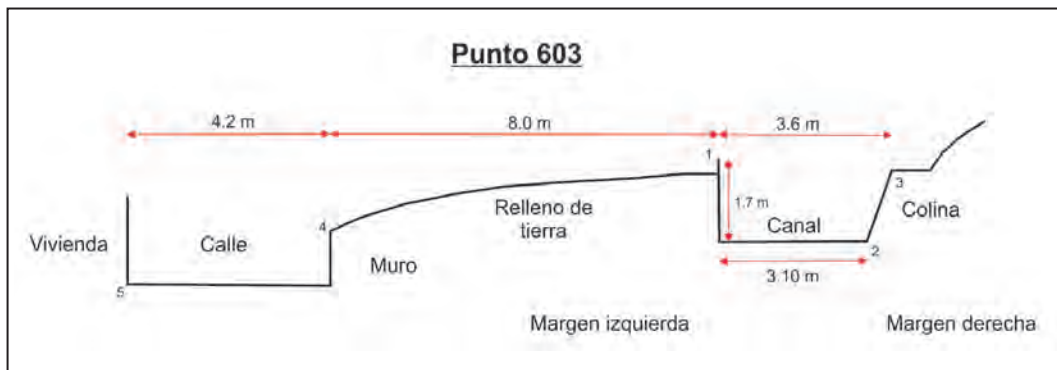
Sección transversal medida en la calle Capitán Novoa (punto de control n° 603), donde se puede observar el muro de encauzamiento de concreto y el relleno de tierra colocado en la cara posterior del muro; también, se puede observar claramente el nivel de la calle en el extremo izquierdo de la sección, que se encuentra por debajo del nivel del lecho actual de la quebrada.
